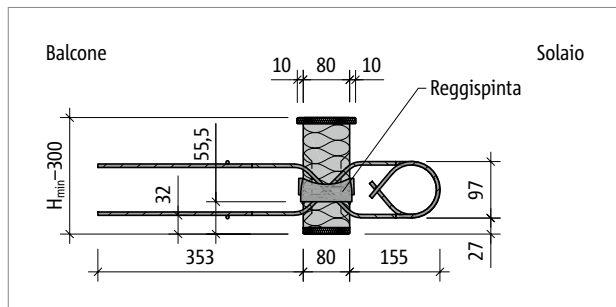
Schöck Isokorb® T tipo QL-VV1: sezione del prodotto
